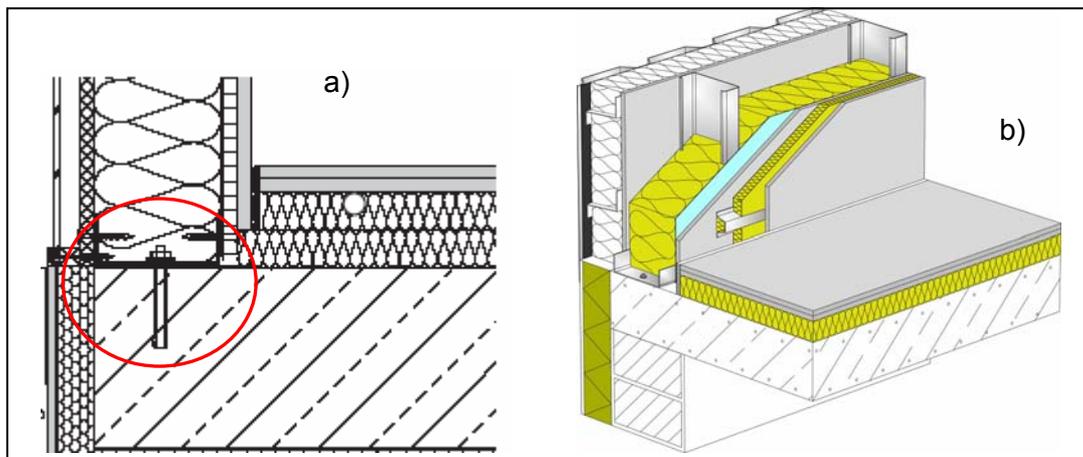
Details: Fußpunkt einer Wand in Stahlleichtbauweise, aus [Z2] / [I6]
